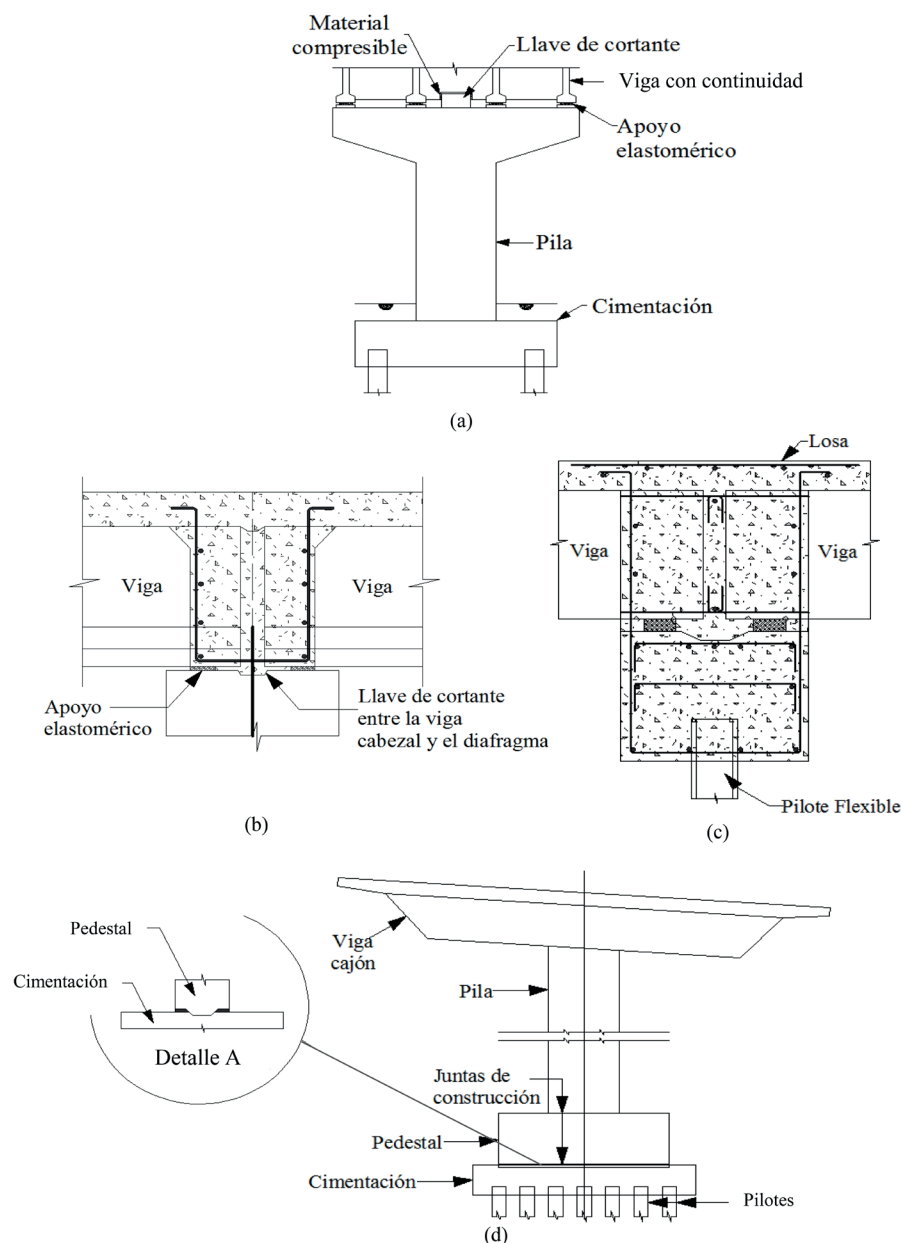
Detalles típicos de continuidad en pilas para puentes integrales: (a) Pilas rígidas con apoyos móviles; (b) Pilas semi-rígidas; (c) Pilas flexibles construidas integralmente con la superestructura; (d) Pilas con goznes en la base e integrales con la superestructura.
